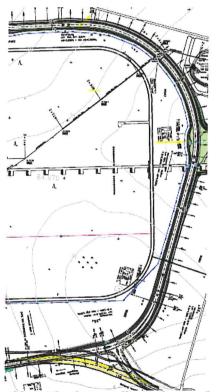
Planfestgestellte Verlegung der Grasseler Straße (Unterlage 5.3, Plan 5-2).
